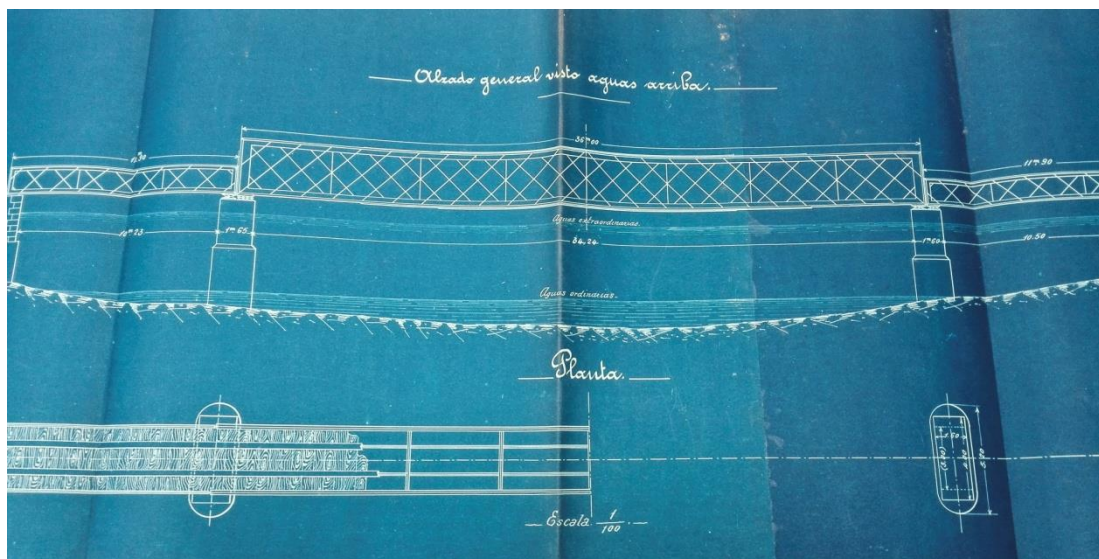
Ayuntamiento de San Martín del Rey Aurelio. Proyecto de un puente metálico sobre el río Nalón en La Oscura. 1900. Archivo de la Demarcación de Carreteras del Estado.
